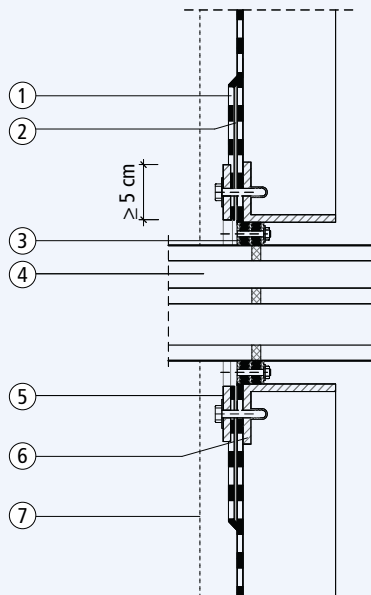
Durchdringung Kelleraußenwand mit Los-/Festflanschkonstruktion bei der Wasserbeanspruchung W2.1-E als Mehrspartenhauseinführung
